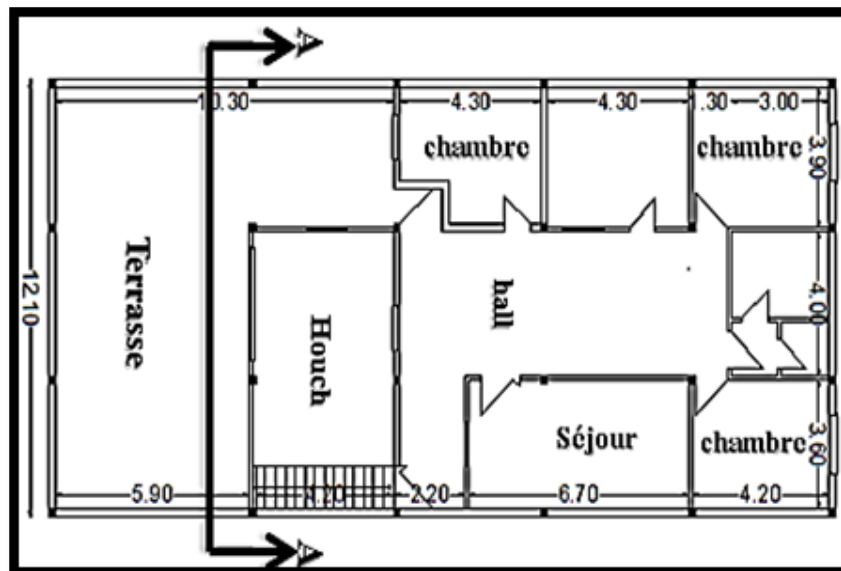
plan de 4<sup>ème</sup> maison a cour –R+1-
